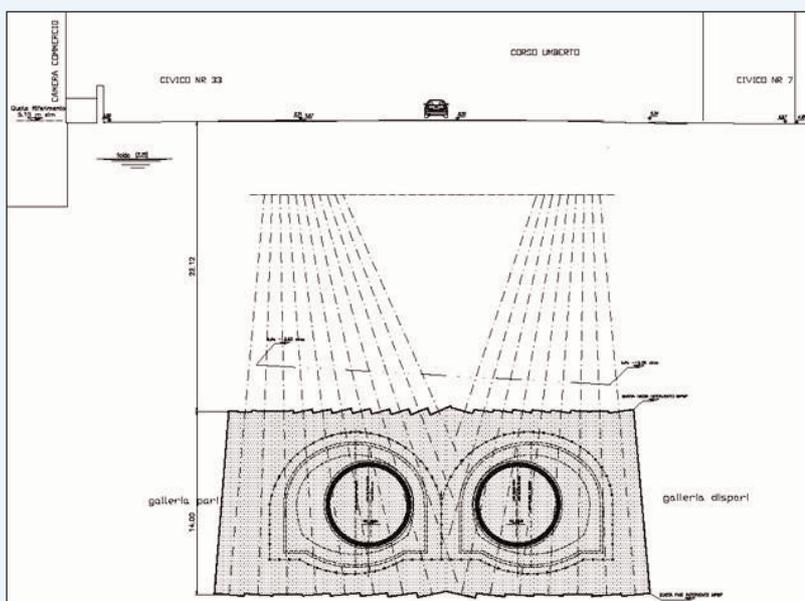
Il tampone di fondo eseguito dal piano campagna: la sezione trasversale
